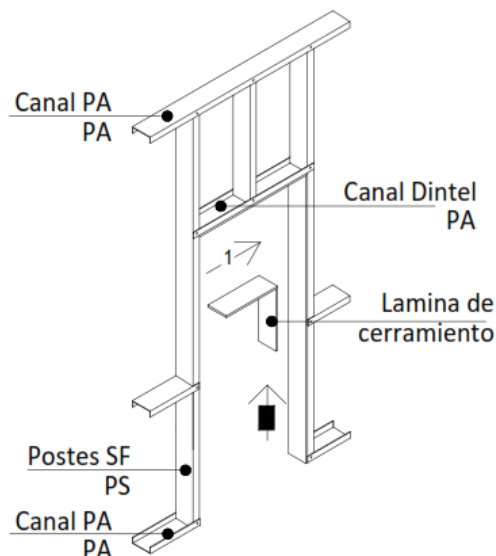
, Vanos en ventanas de muros de paneles a la medida. (Fuente: propia del autor)
